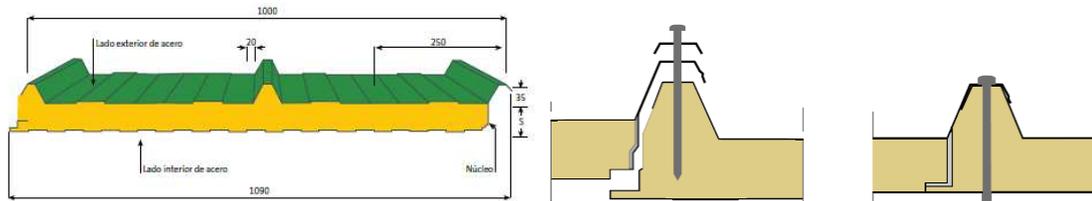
Panel Sandwich de 3 grecas para la cubierta. Ilustración 10. Detalle de la unión del panel sándwich.
